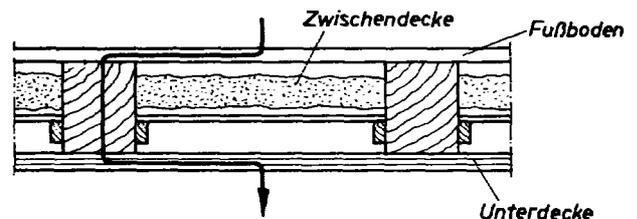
Schallübertragung bei Holzbalkendecken, wenn Fußboden und Unterdecke mit den Balken fest verbunden sind.
